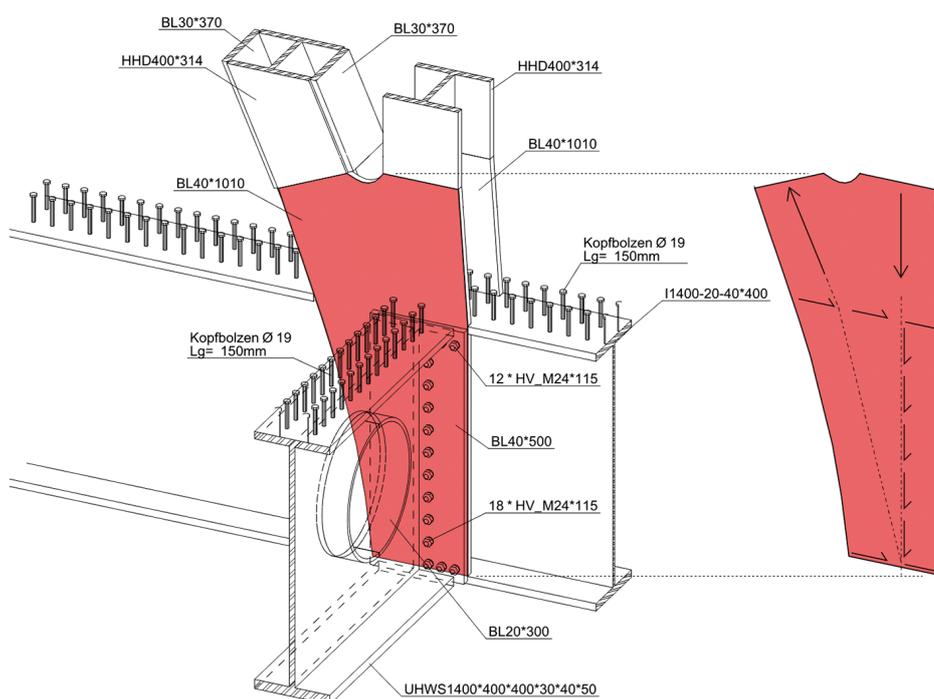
Fachwerkknoten mit Kräfteplan der Knotenbleche
